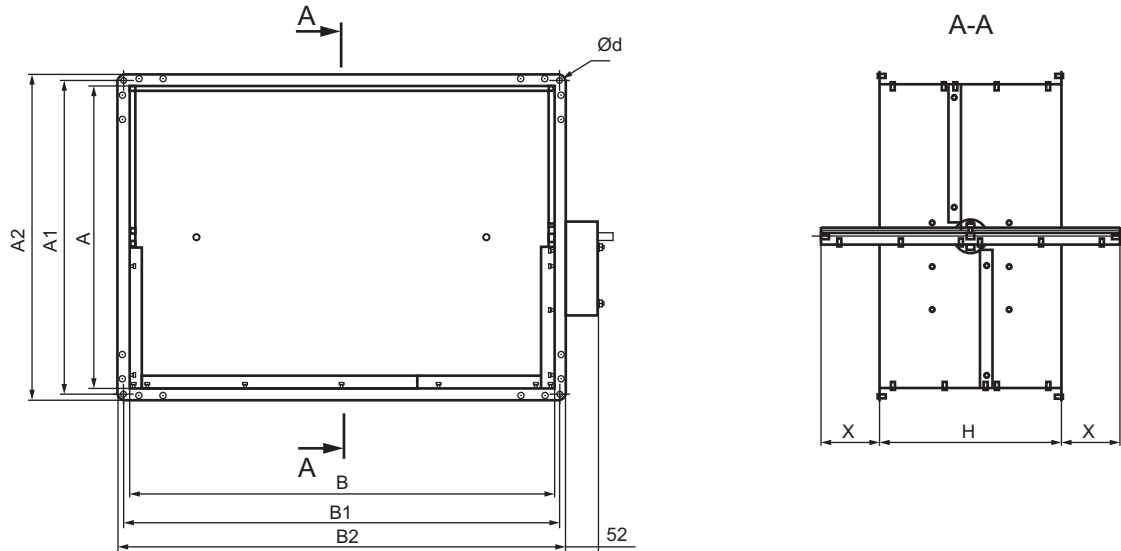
Габаритные и присоединительные размеры клапанов типа КВМ-П прямоугольного сечения.
